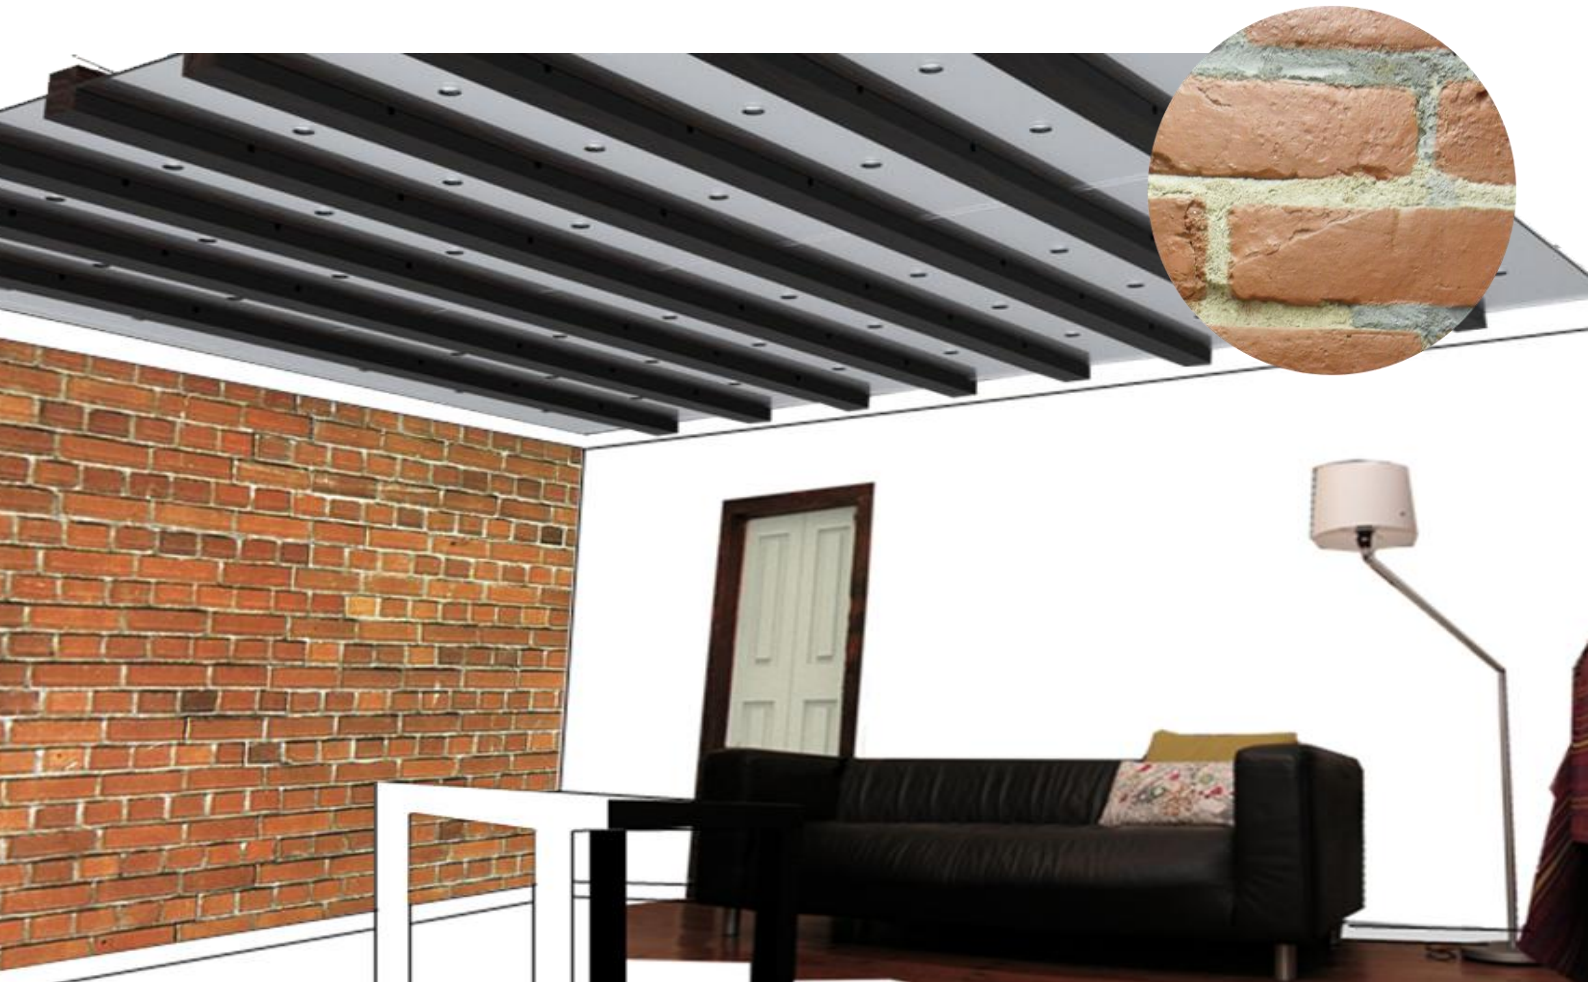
Vista esquemática de sala com pormenor de tijolo, alternativa 1 criação do autor.
